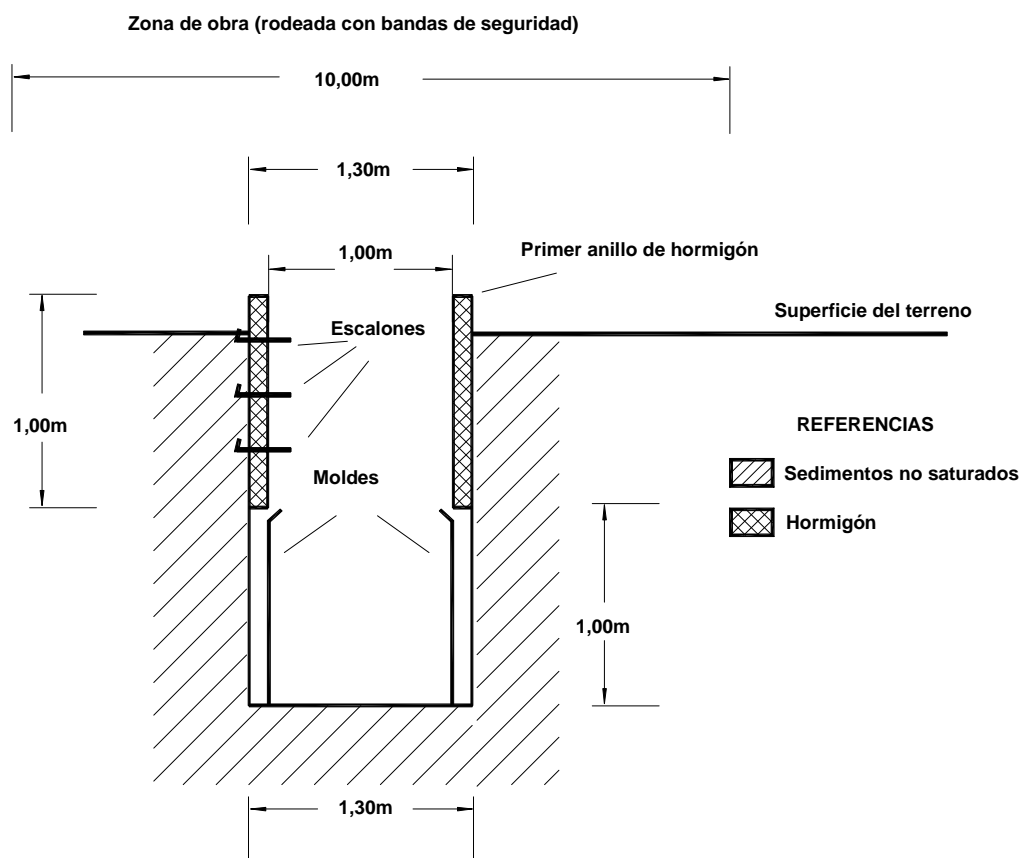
Corte longitudinal, en el que se muestra el primer metro hormigonado y la colocación de los moldes en el segundo tramo de excavación.
